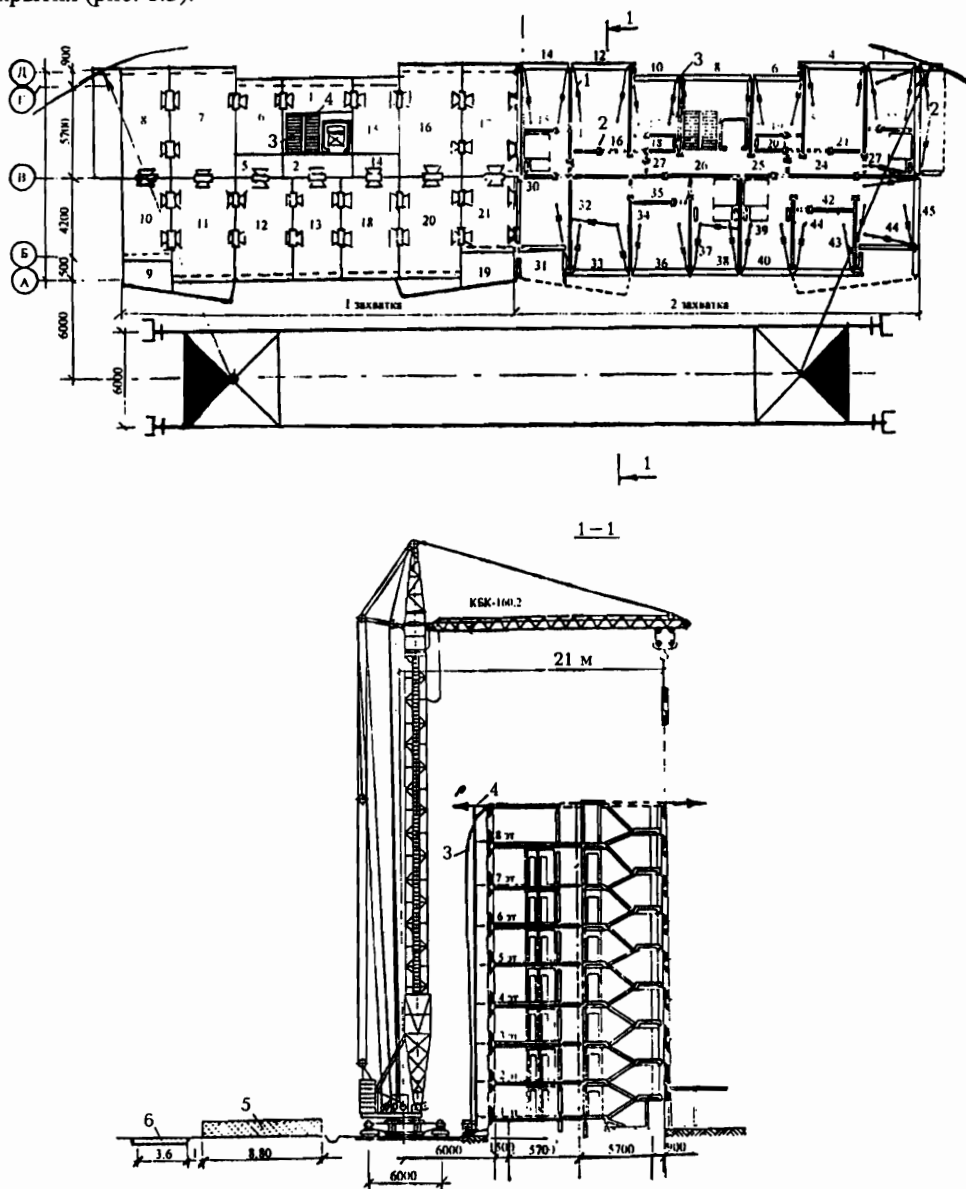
Технологическая последовательность монтажа сборных элементов типового этажа здания с разбивкой на захватки и схемой временного крепления наружных и внутренних стеновых панелей: 1 – подкос; 2 – торцевая стойка; 3 – вертикальная напрягаемая арматура; 4 – горизонтальная напрягаемая арматура; 5 – склад сборных конструкций; 6 – временная автодорога
